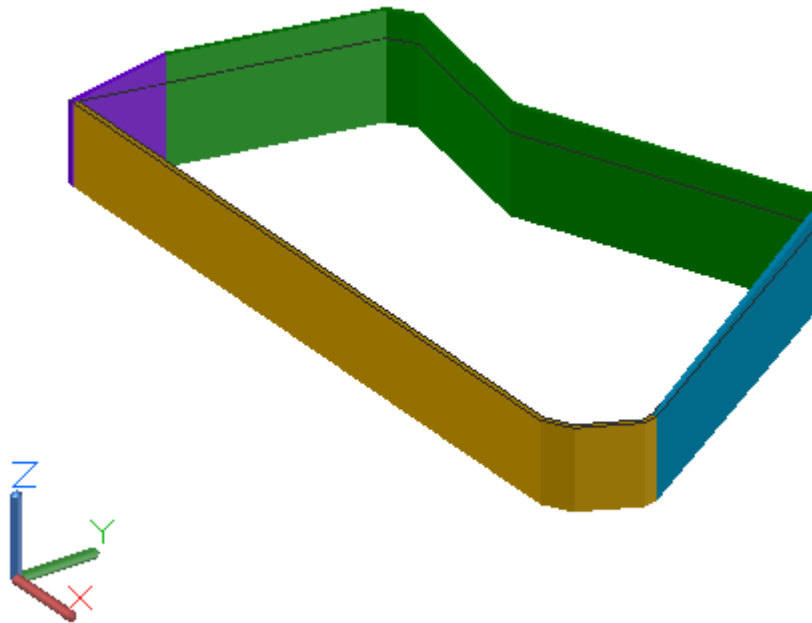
Vista 3D de los muros tipo. AutoCAD Civil 3D
